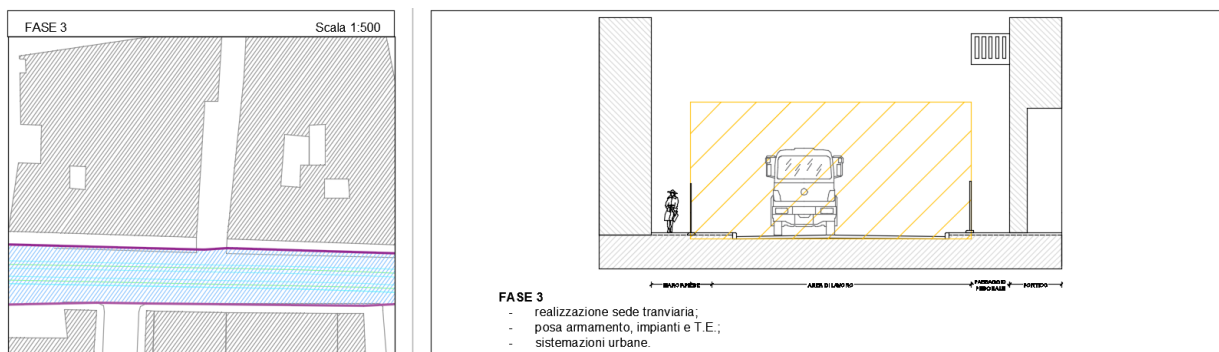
Tipologico cantiere con sede promiscua Fase 3
